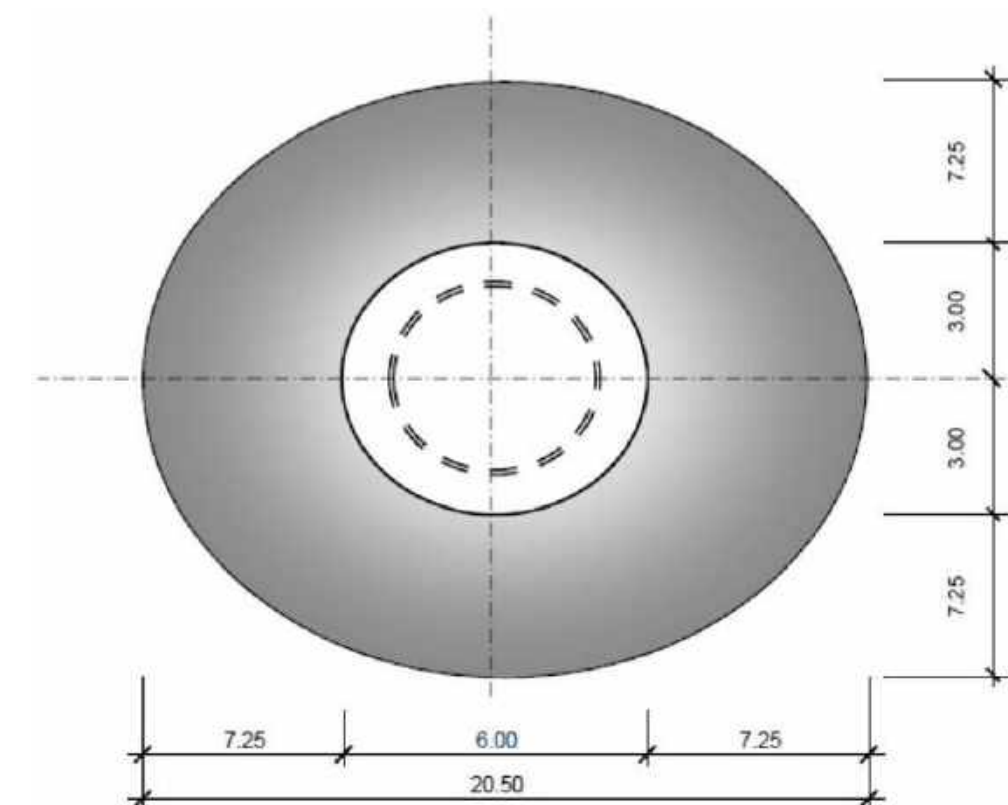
Vue en plan de fondation d'éolienne de type massif poids - V126 (Source : VESTAS)
